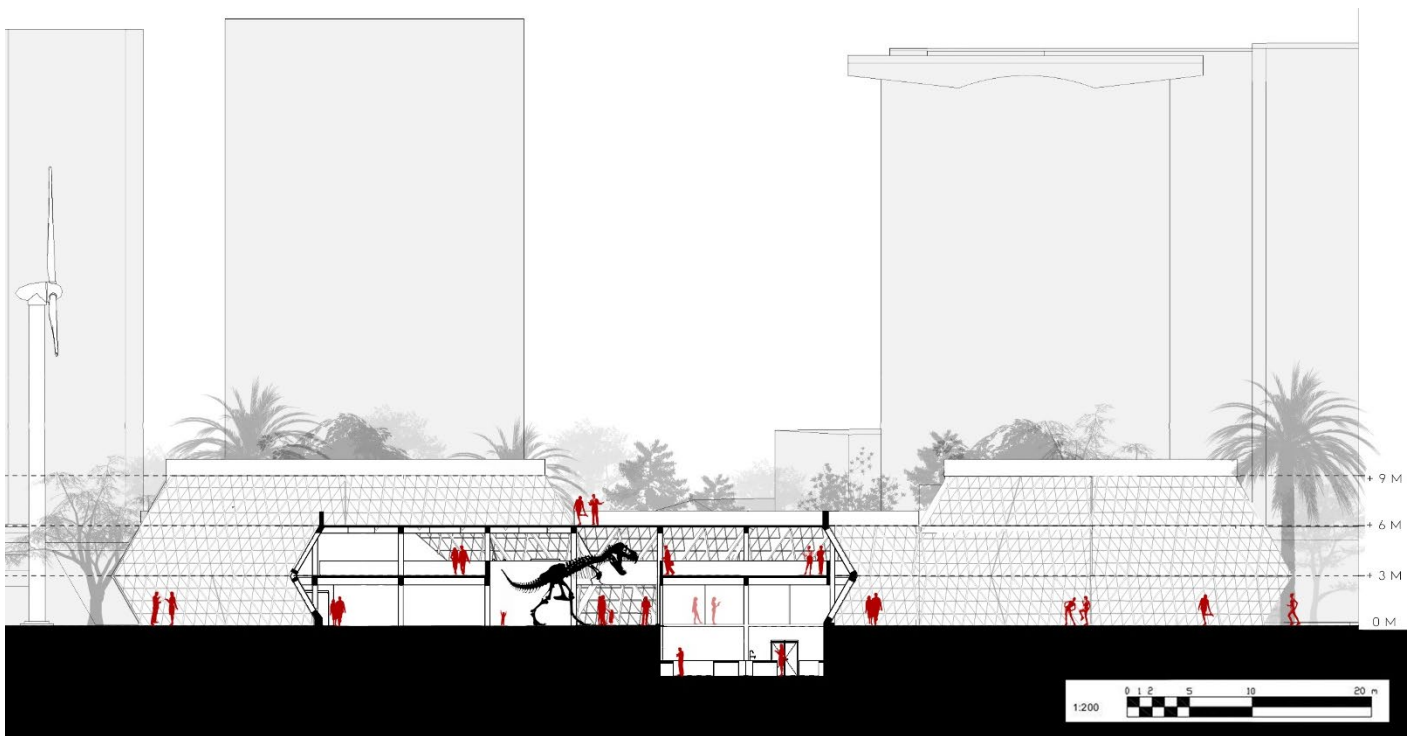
Corte longitudinal C-C'. Elaboración propia.
